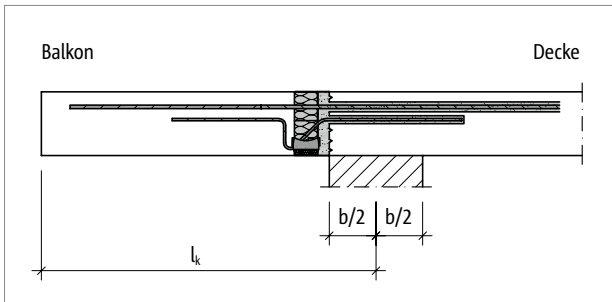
Schöck Isokorb® RT Typ K: Statisches System; direkte Lagerung
